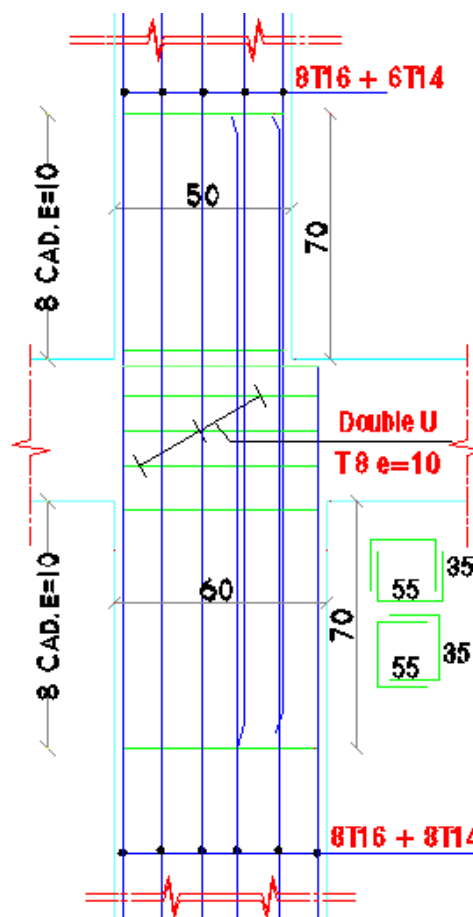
Ferrailage de recouvrement des poteaux (60×40) cm<sup>2</sup> et (50×40) cm<sup>2</sup>.
